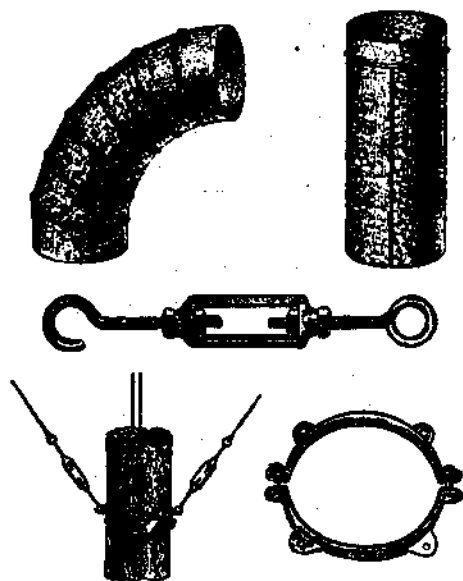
Устройство ответвлений в вытяжных трубах.
